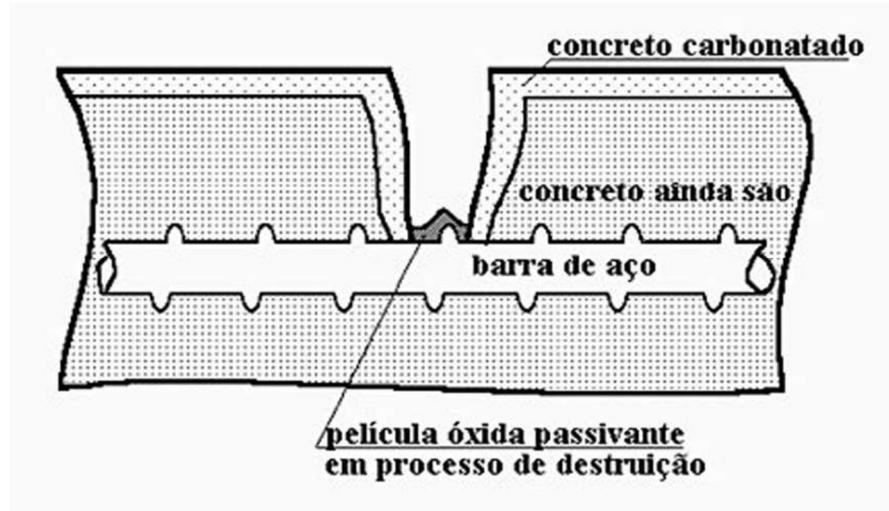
Carbonatação condicionada pela fissuração (RIPPER, 1998)
